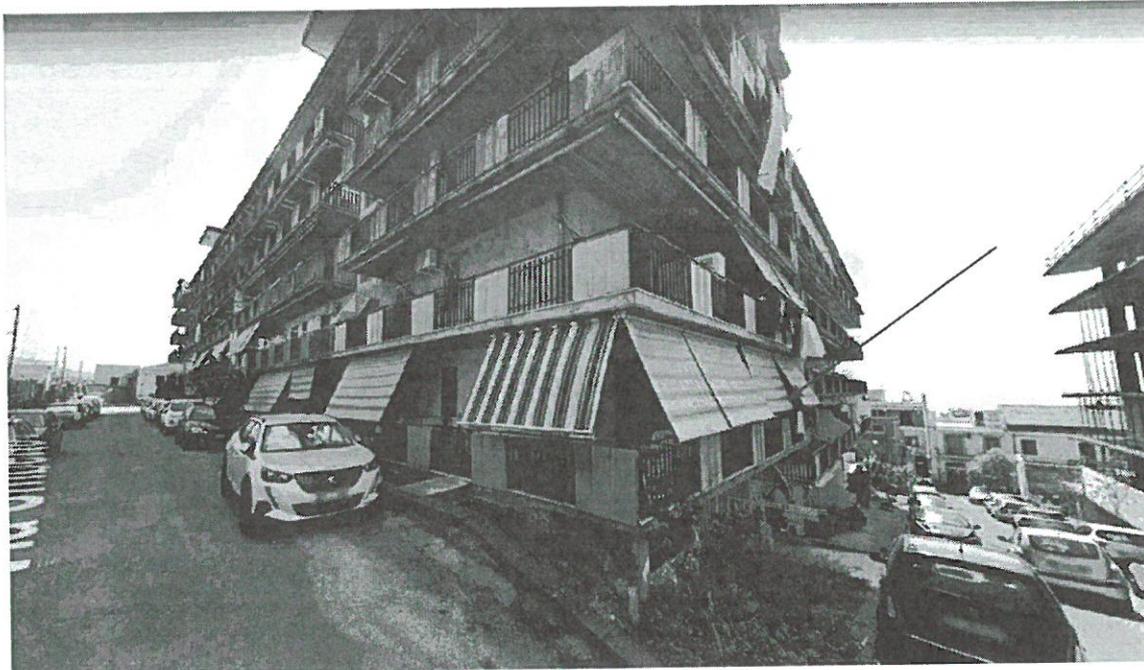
Prospetto NORD-OVEST dell'immobile in via Umberto I
